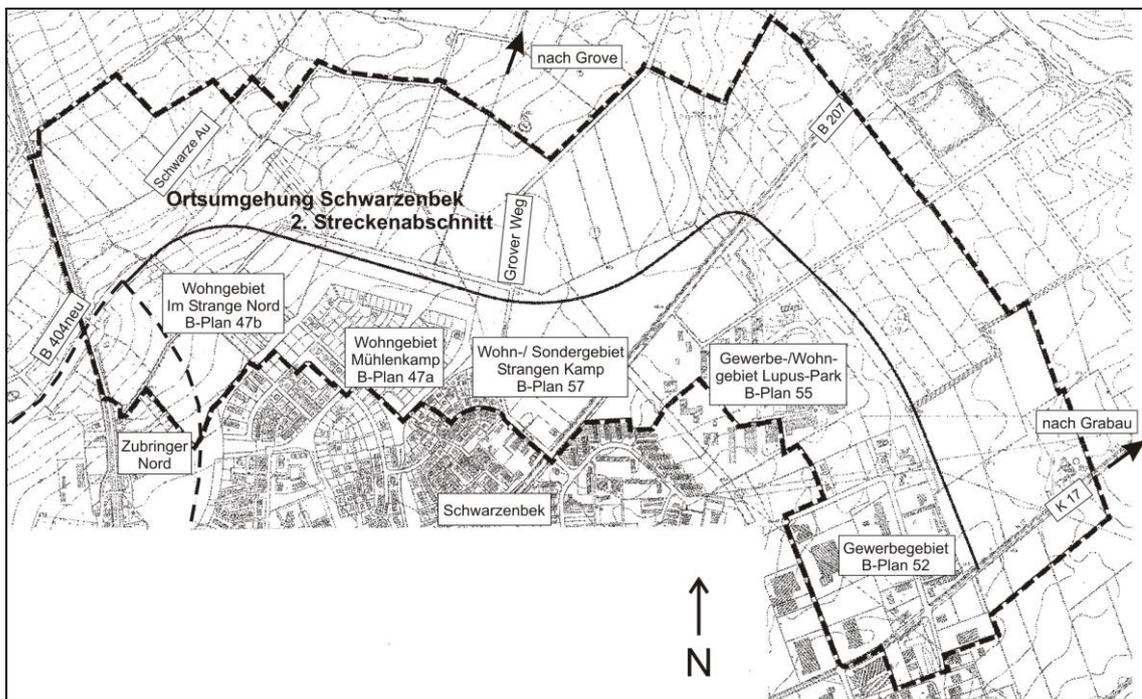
Lage der geplanten Trasse und Abgrenzung des Plangebietes o. M.
